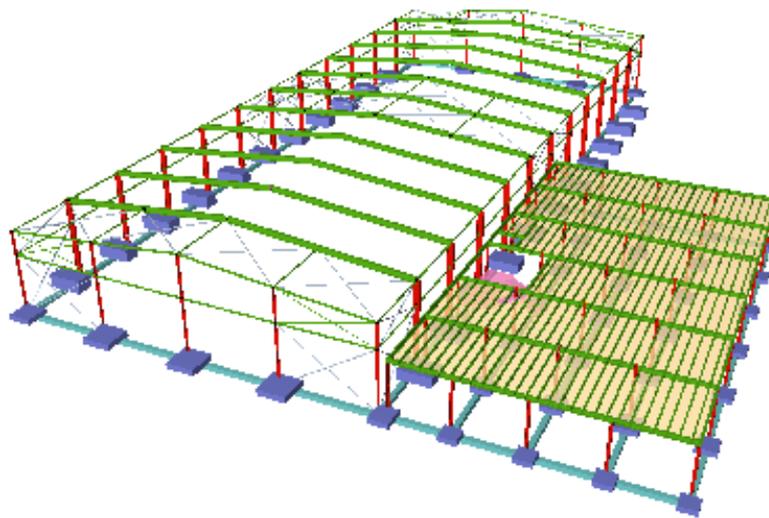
Vista 3D del edificio (Fuente: CypeCad)
